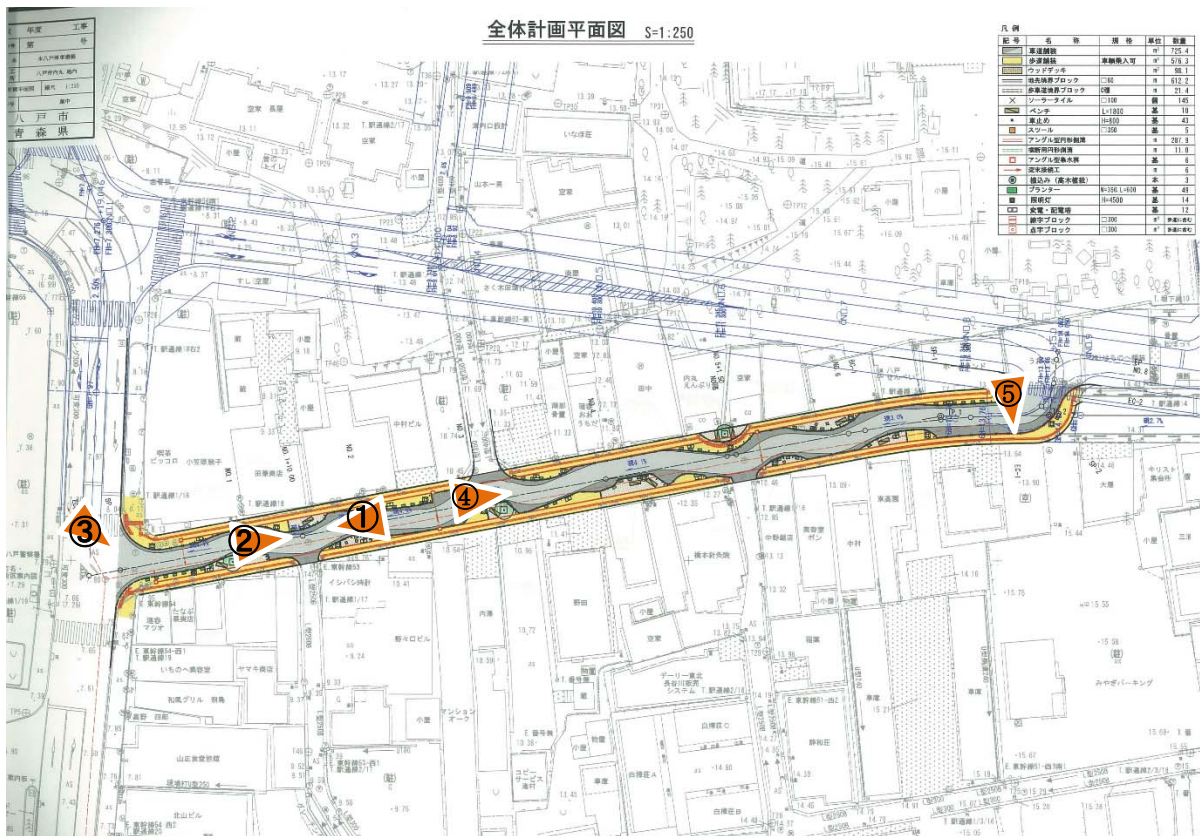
本八戸駅通りの再整備計画平面図（現状）
